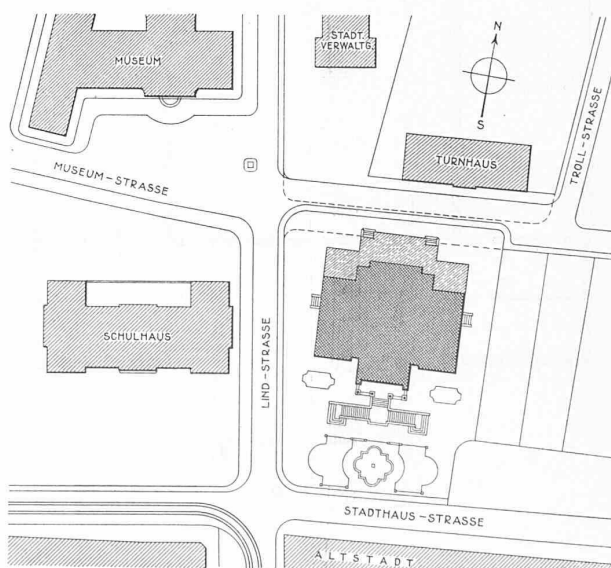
Lageplan des Stadthauses (kreuzweise schraffiert) mit dem geplanten Anbau an der Nordseite. — Masstab 1:2000.
